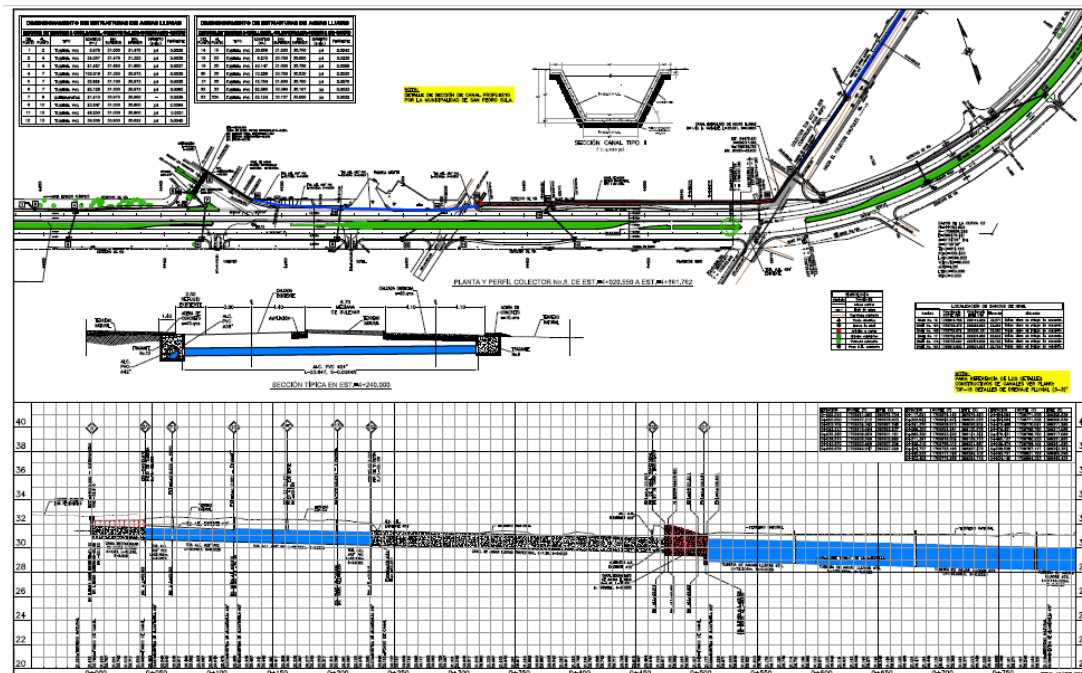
Plano de Planta General y Perfil de Colector No.8.
